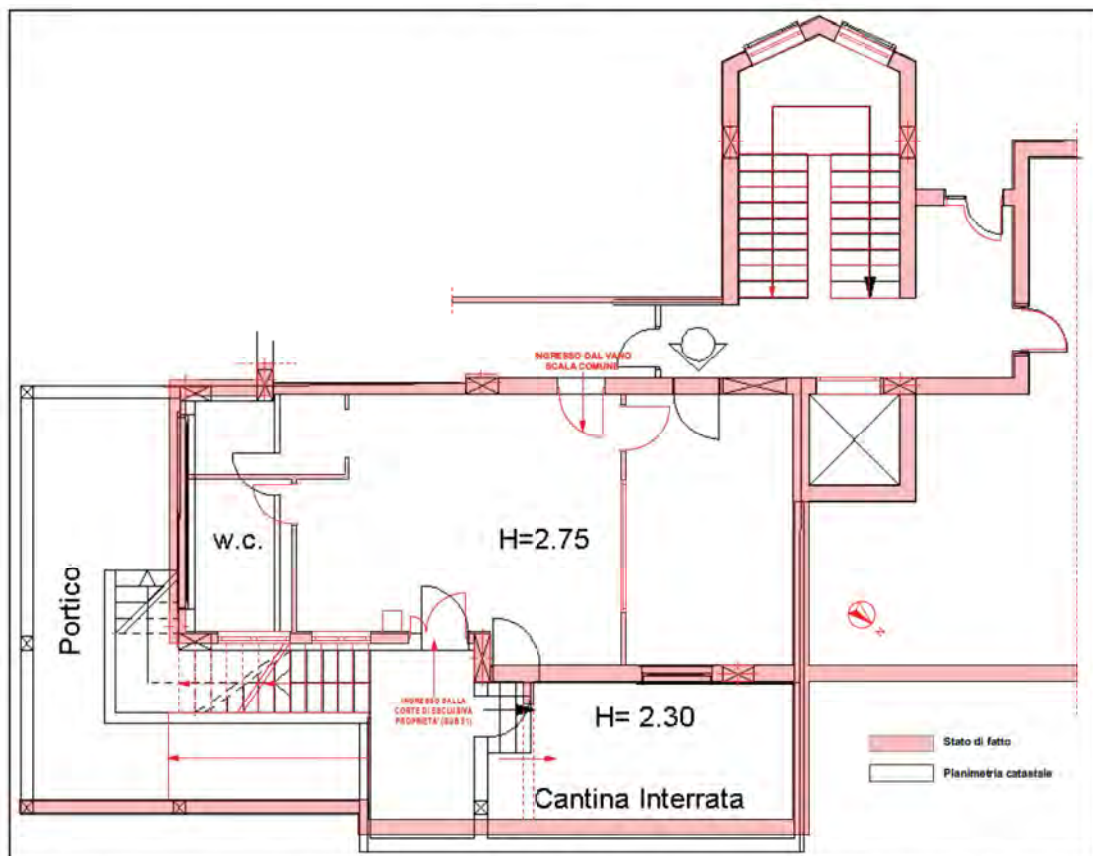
Sovrapposizione visura planimetrica catastale dell'appartamento pignorato (foglio 74 particella 709 sub 1-51) e rilievo effettuato in fase di sopralluogo – Piano Terra
